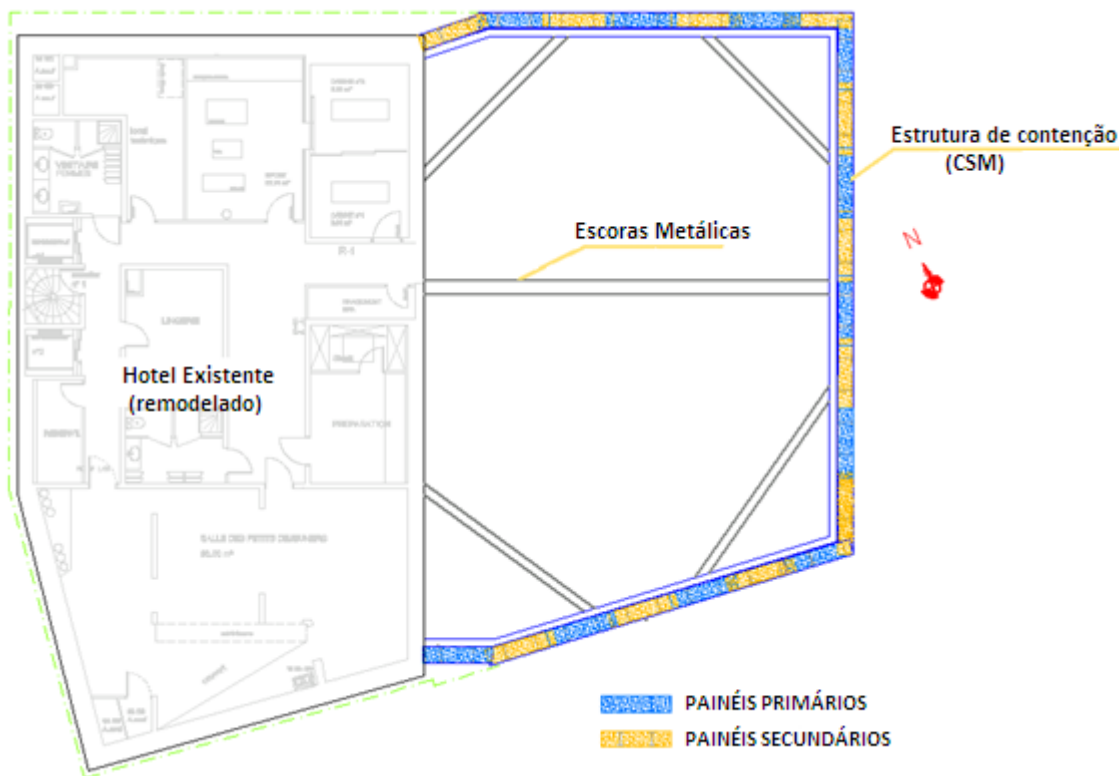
Planta da Estrutura de Contenção e do Escoramento Horizontal
